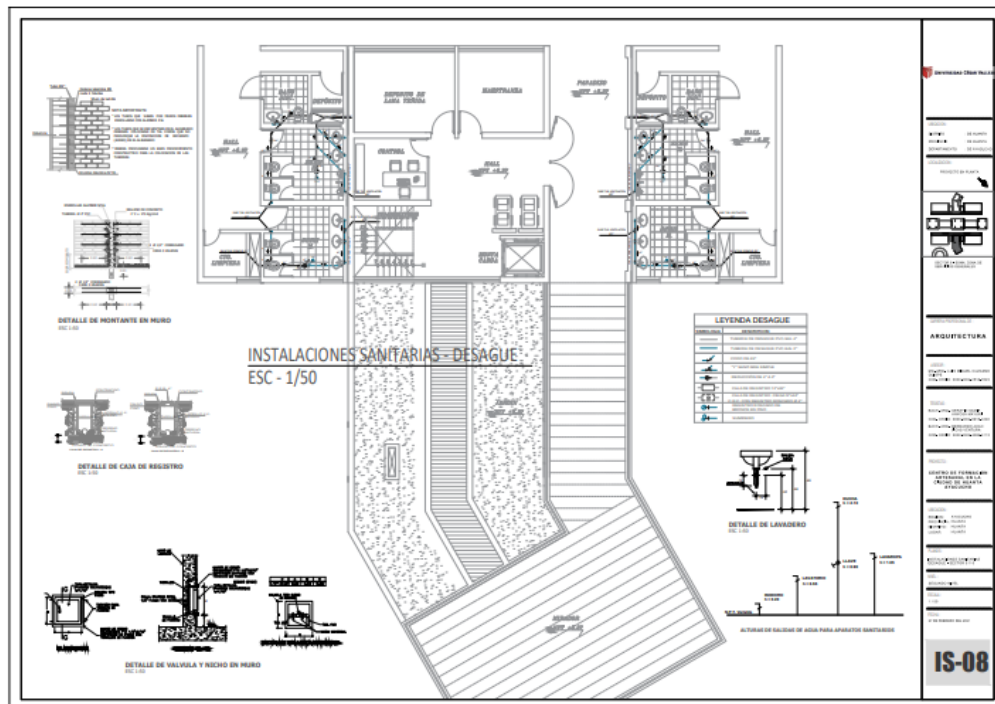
Plano de instalaciones sanitarias desagüe piso 2 - escala 1/50.
